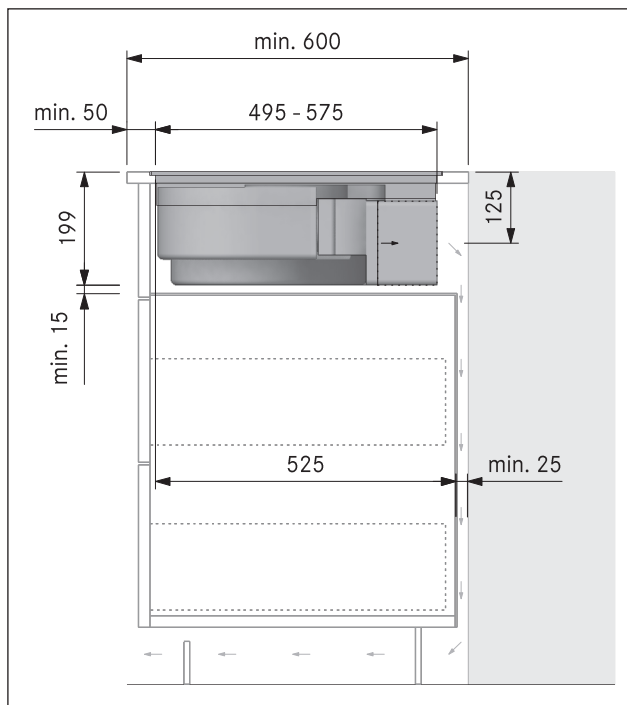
Dimensioni di montaggio con sistema filtrante variante di montaggio B, profondità piano di lavoro 600 mm
